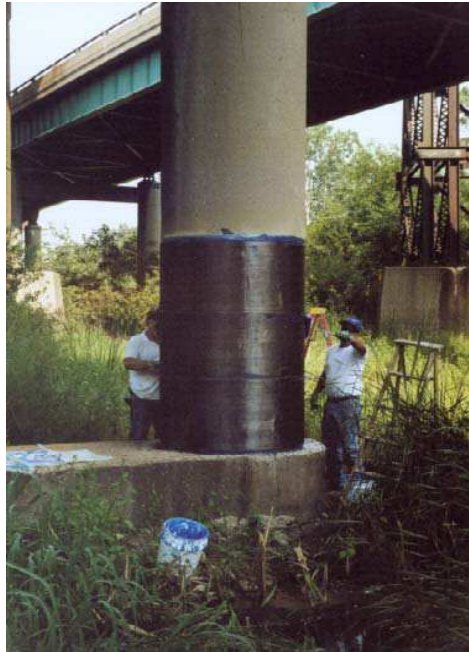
Encamisamento de pilar (MASTER BUILDERS, 2001)
